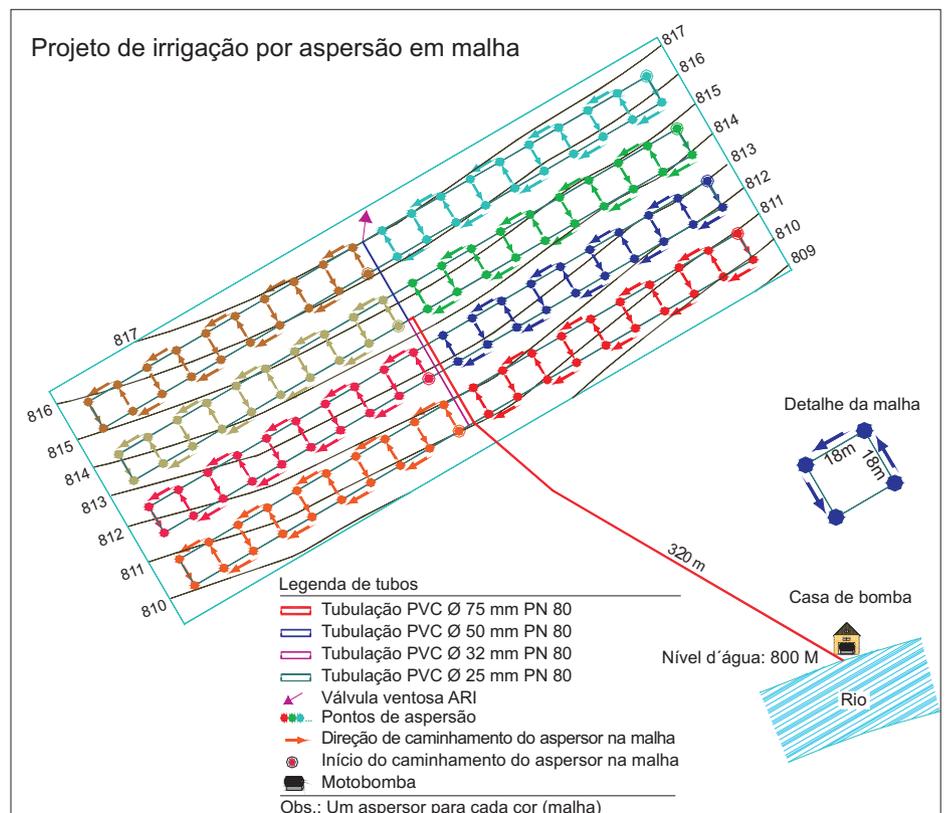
Planta planialtimétrica da área e disposição das malhas
